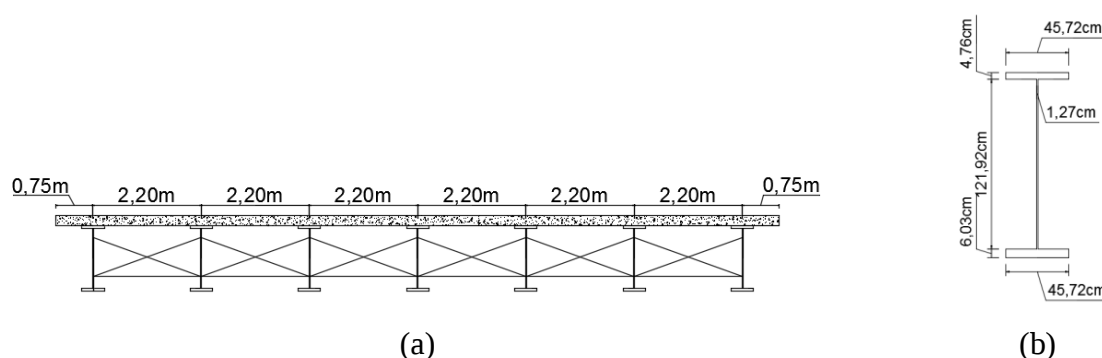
(a) Seção transversal da ponte; (b) Detalhe da seção transversal da viga
